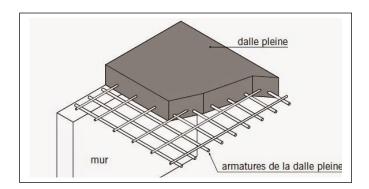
Modèle de plancher en Béton armé¹⁰².
